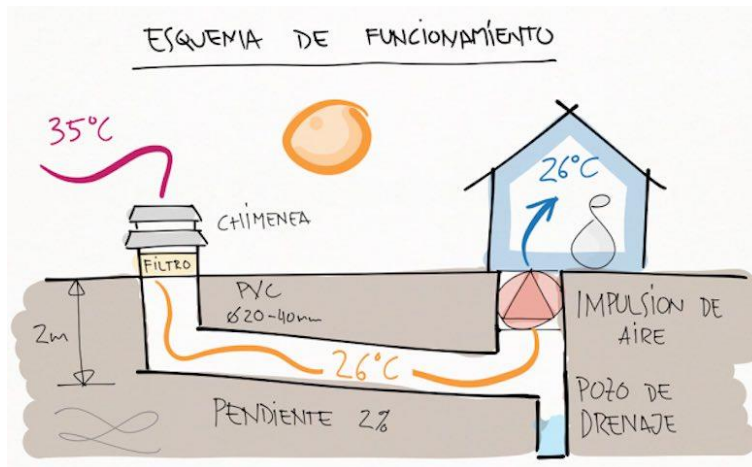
(blog.about-haus.com): Secció tipo d'un pou canadenc o provençal.
